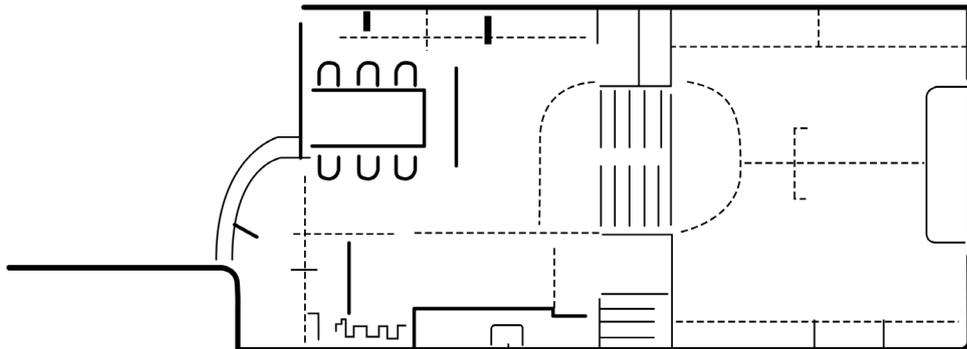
Segunda planta de la vivienda sencilla, 1932.
